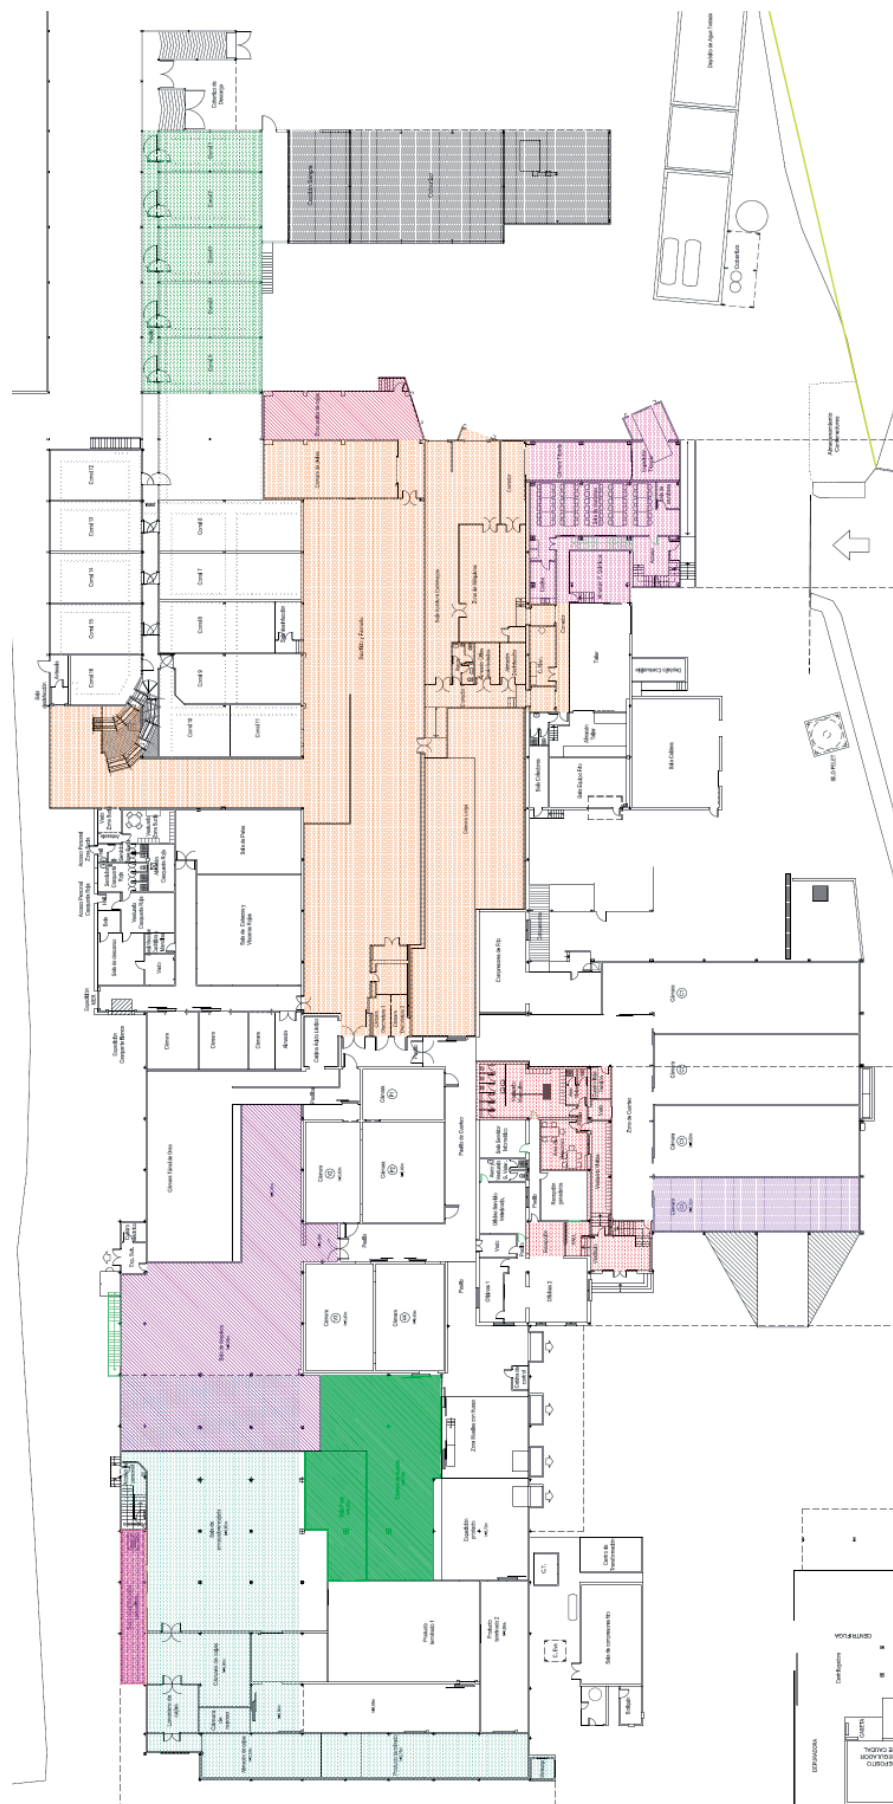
Ampliación zona central plano en planta de la instalación, en el que se resaltan las zonas en las que se llevarían a cabo modificaciones
